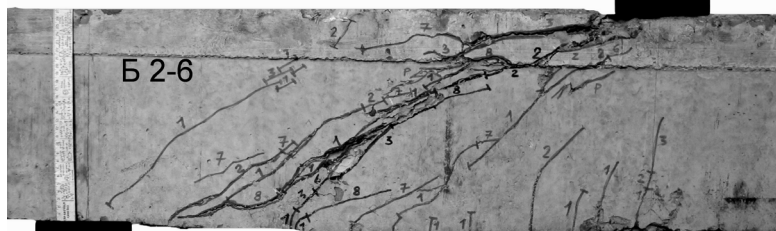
Разрушение железобетонных балок по наклонному сечению
